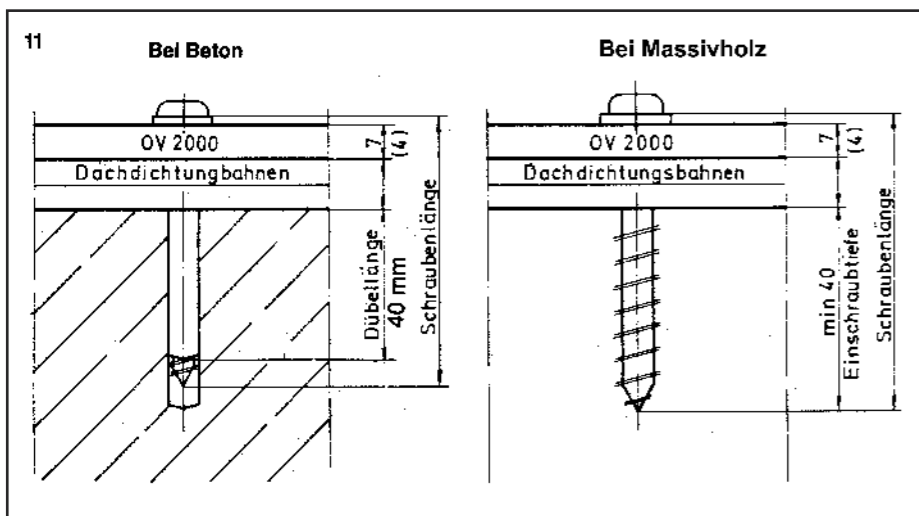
Zur Befestigung sind folgende korrosionsbeständige Schrauben zu verwenden.
